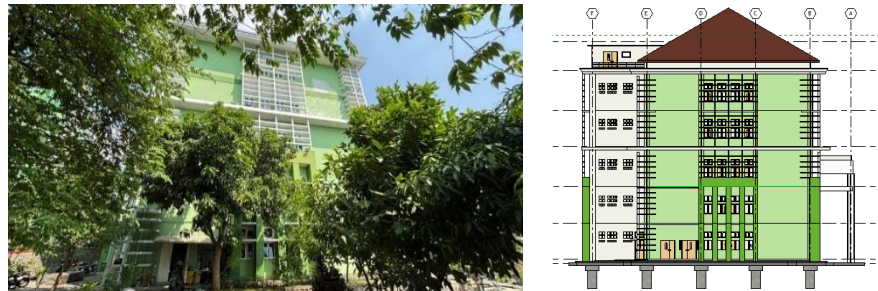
10 Tampak Timur Laut Gedung Gizi
